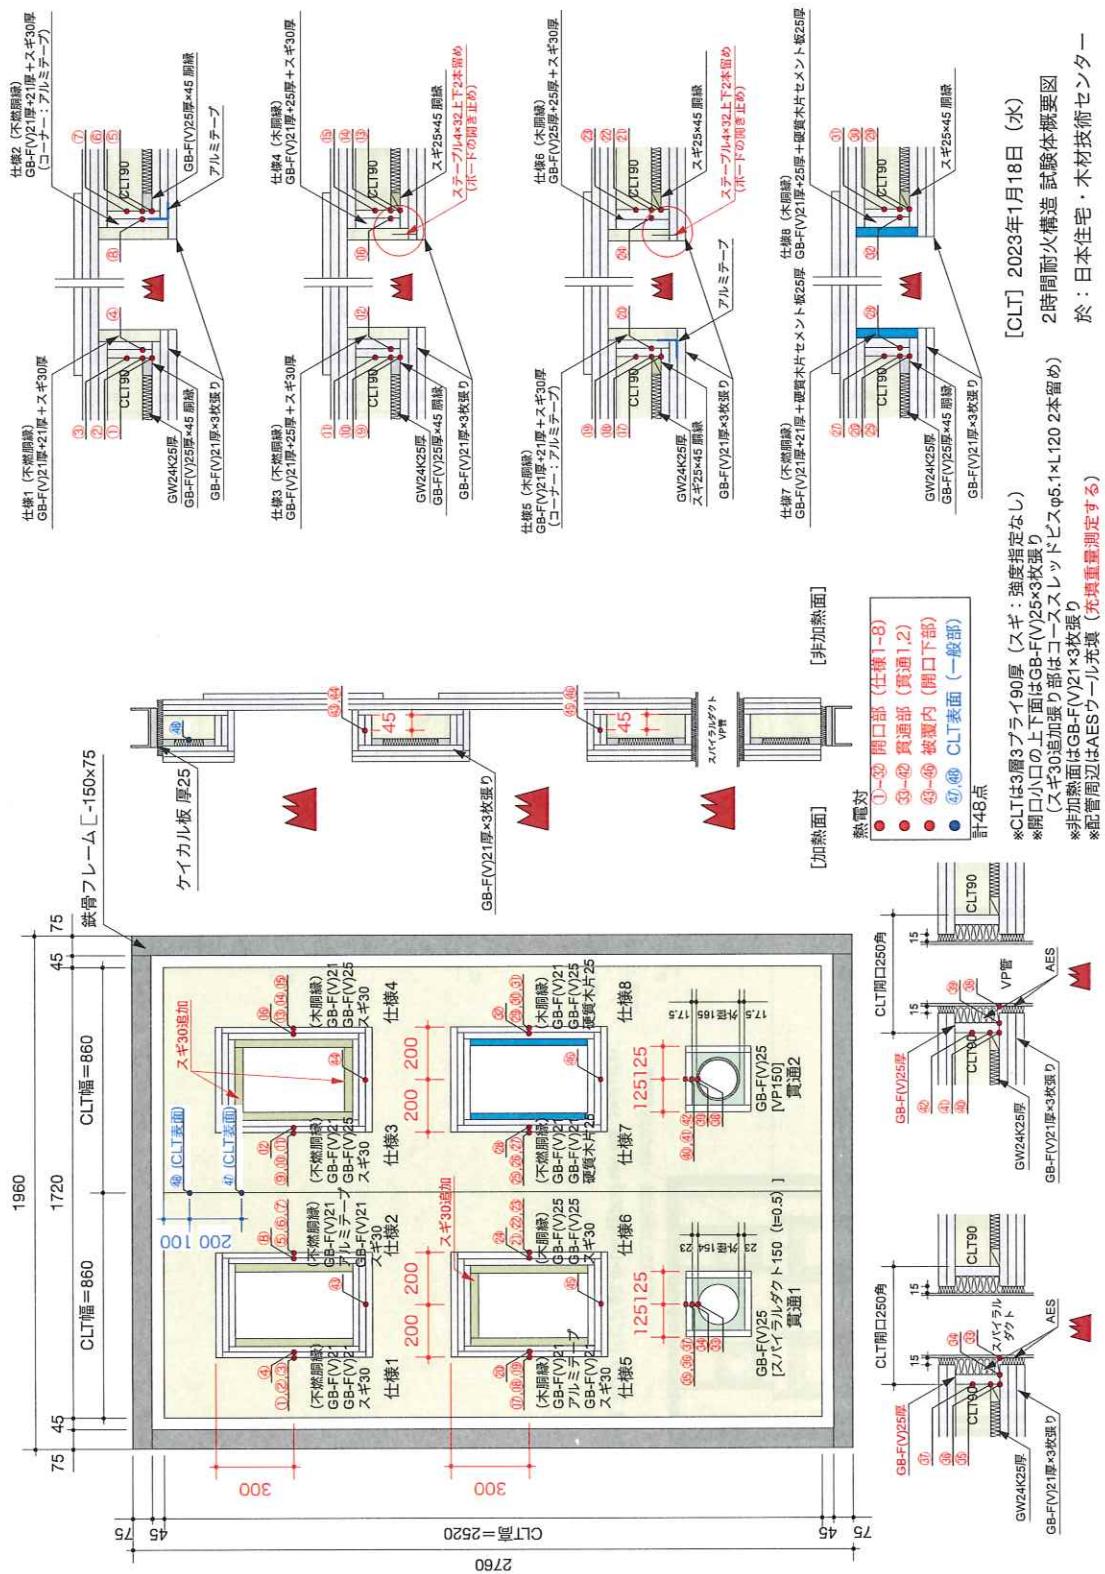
試験体 2 の熱電対位置 (単位 : mm)
